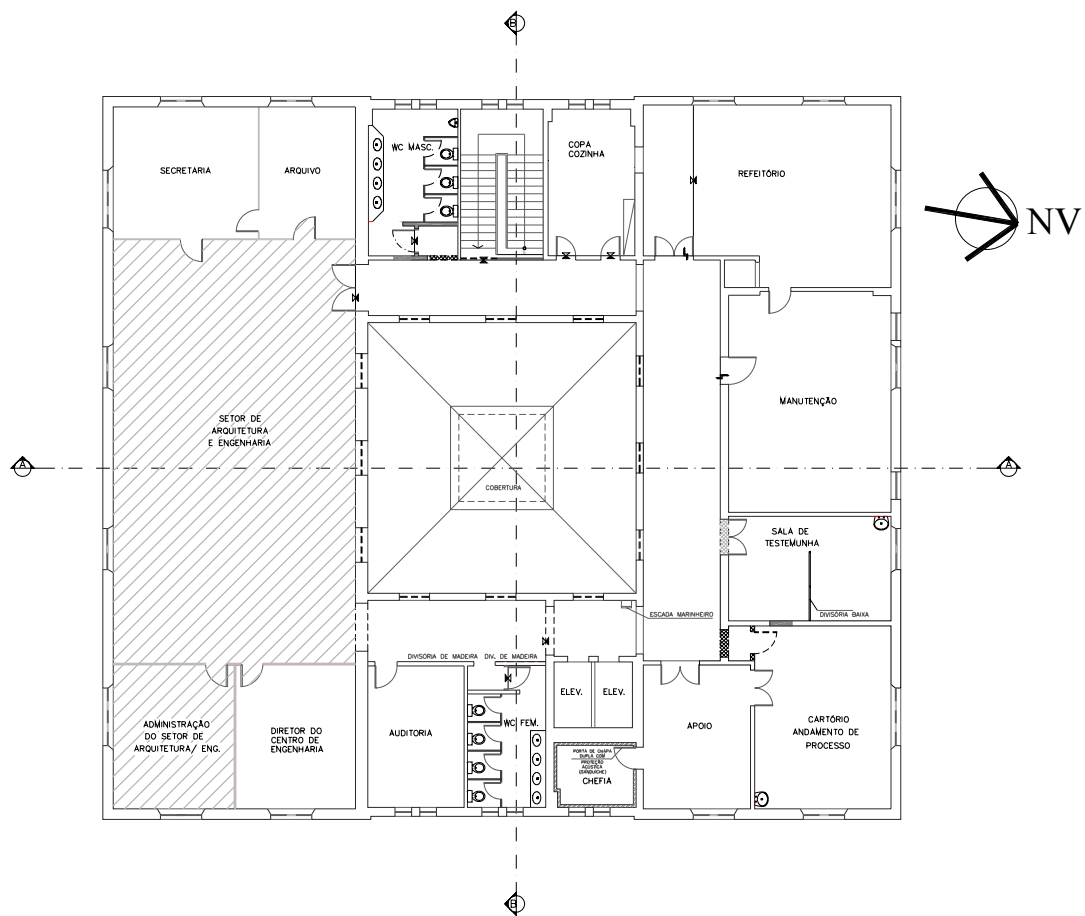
planta baixa do 3^o pavimento – edifício 184;
